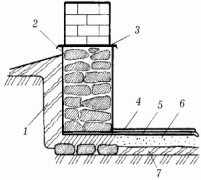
Гидроизоляция фундаментов традиционными рулонными материалами: 1 – глина; 2 – слой цементного раствора, снаружи покрытый битумом; 3 – гидроизоляция; 4 – цементный пол; 5 – гидроизоляция; 6 – слой керамзита; 7 – глина.
